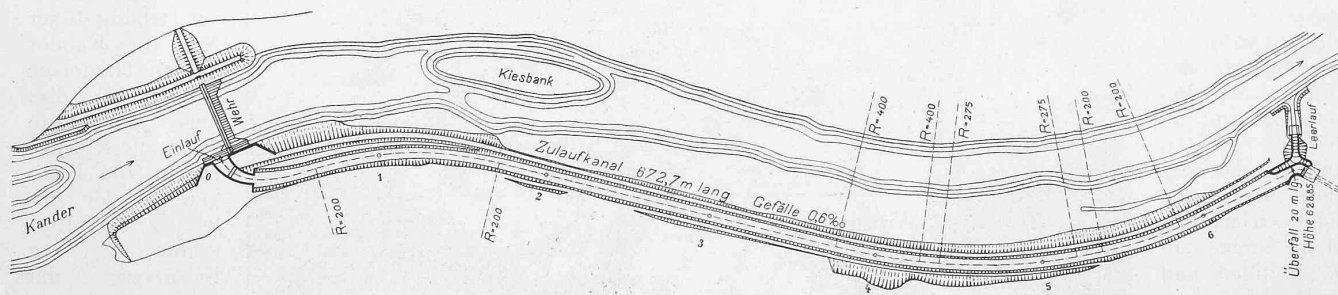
Lageplan des Zulaufkanals mit Wehr, Ueberfall und Stolleneinlauf. — Masstab 1:4000.
